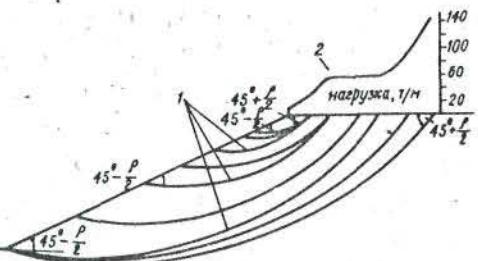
Схема к упрощенному расчету допустимых нагрузок на уступ (второй случай): 1—расчетные поверхности; 2—кривая допустимых нагрузок
